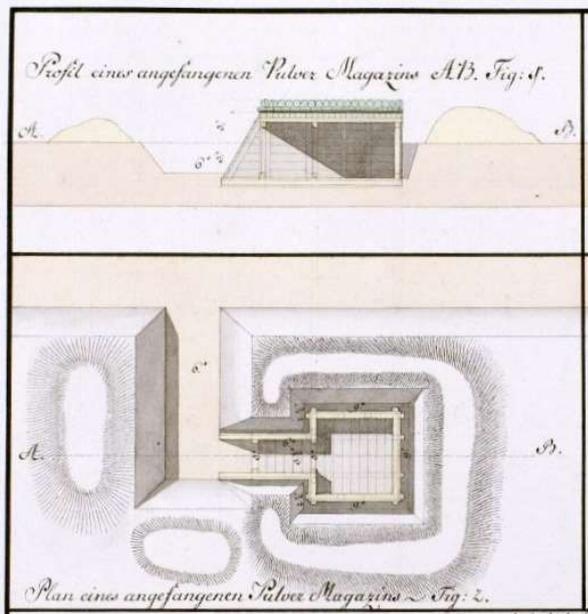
Versenktes, gedecktes provisorisches Magazin einer Belagerungsbatterie im Schnitt und in Aufsicht. Der Boden wurde durch Planken abgedeckt und
